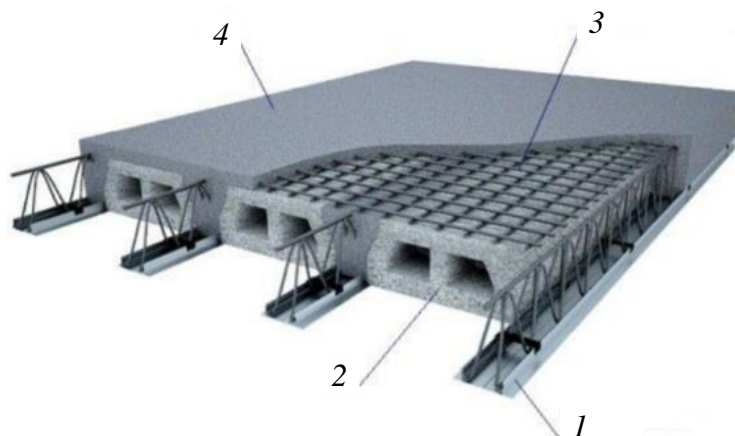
Устройство сборно-монолитного перекрытия: 1 – несущая балка; 2 – пустотный блок; 3 – арматурная сетка; 4 – бетон
